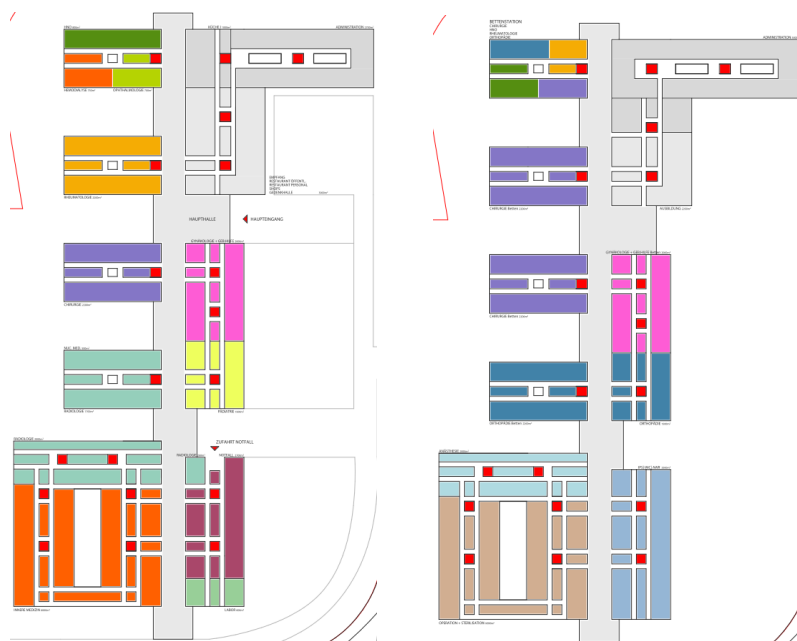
rez-de-chaussée/1^{er} étage, plan schématique Variante Pré Vert
